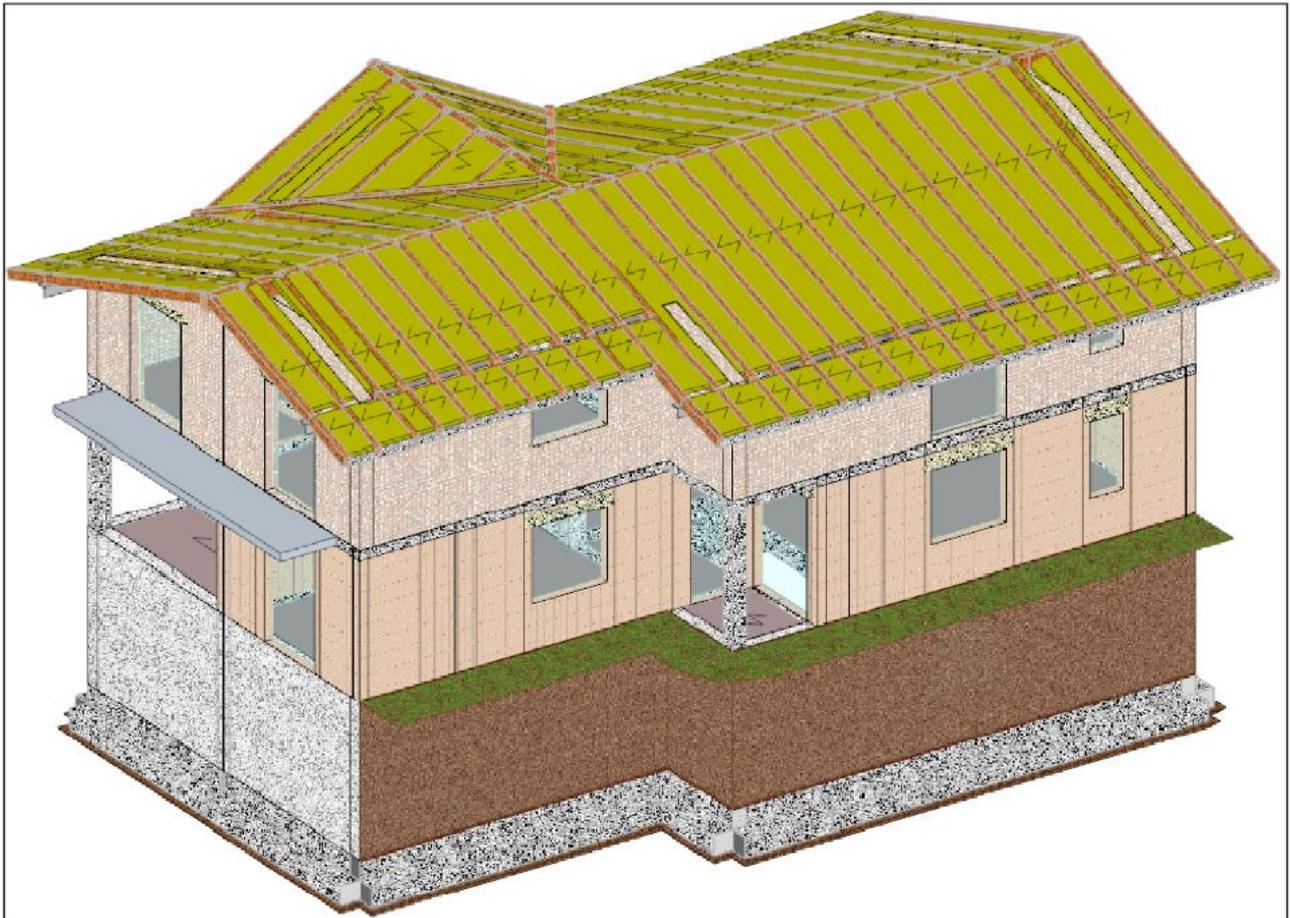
progetto con utilizzo di muratura portante di laterizio
